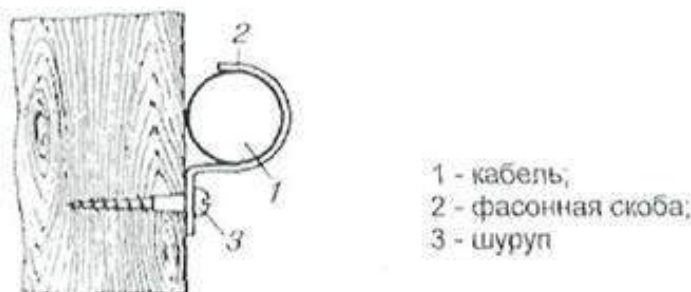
Крепление фасонной скобы к деревянной стене.
